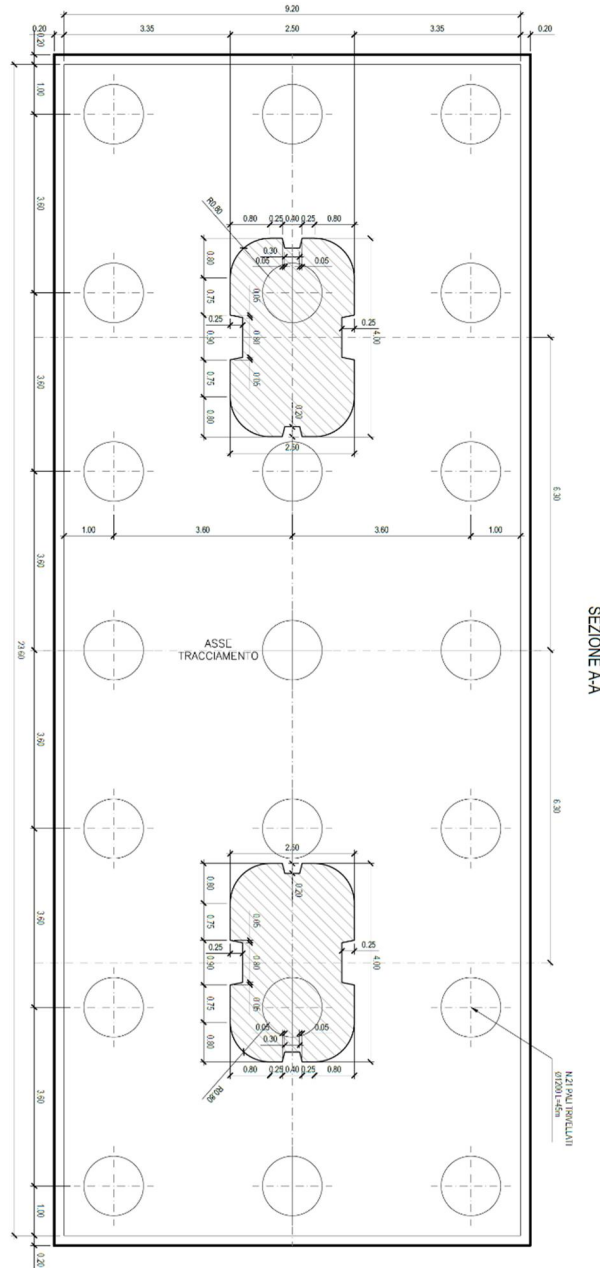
Sezione Tipica allo Spiccato Fondazione (P3).
